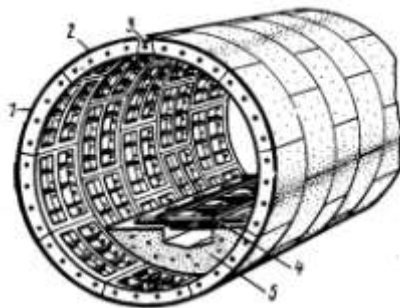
Железобетонные туннельные кольца. 1 – нормальный сегмент, 2 – смежный сегмент, 3 – замковый сегмент, 4 – рельсовый путь, 5 – бетонное основание пути.
